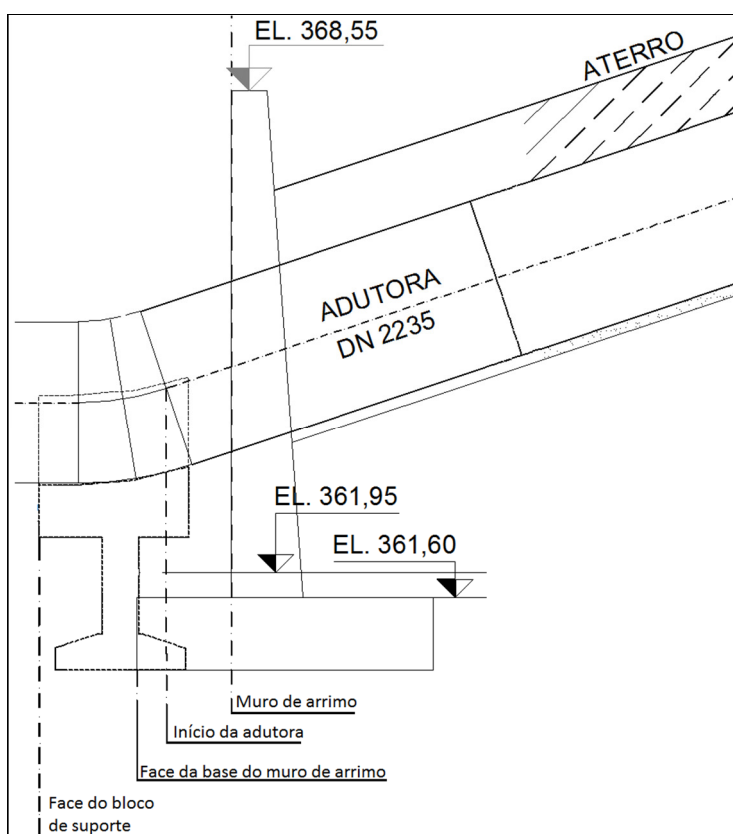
Vista lateral do muro de arrimo (primeira solução)
